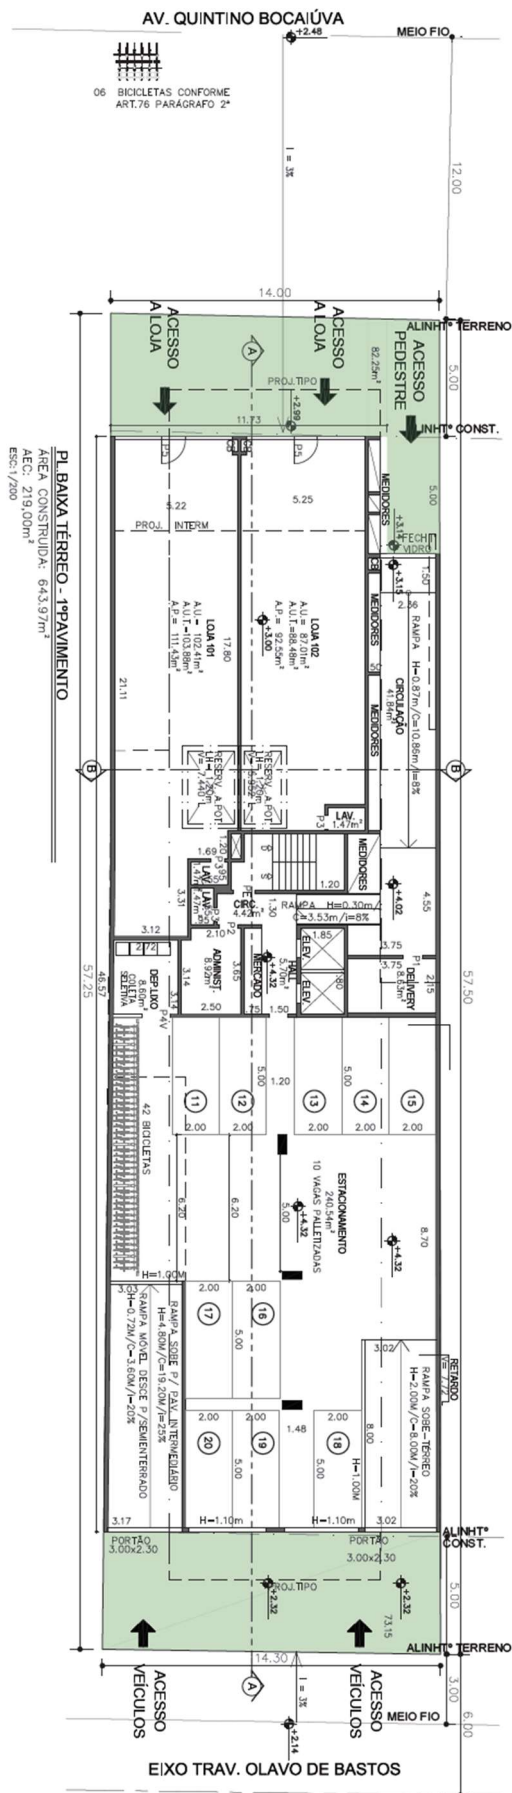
Térreo – 1º pavimento - Fonte: Projeto Legal
